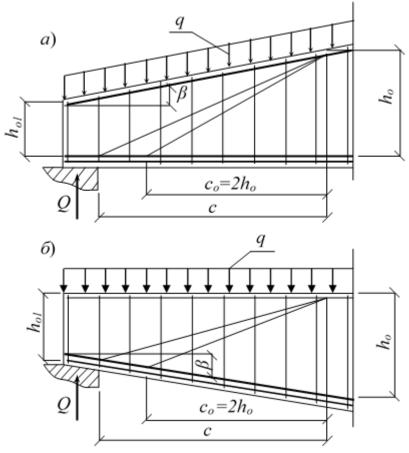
Наклонные сечения балок с переменной высотой сечения а - балка с наклонной сжатой гранью; б - балка с наклонной растянутой гранью
